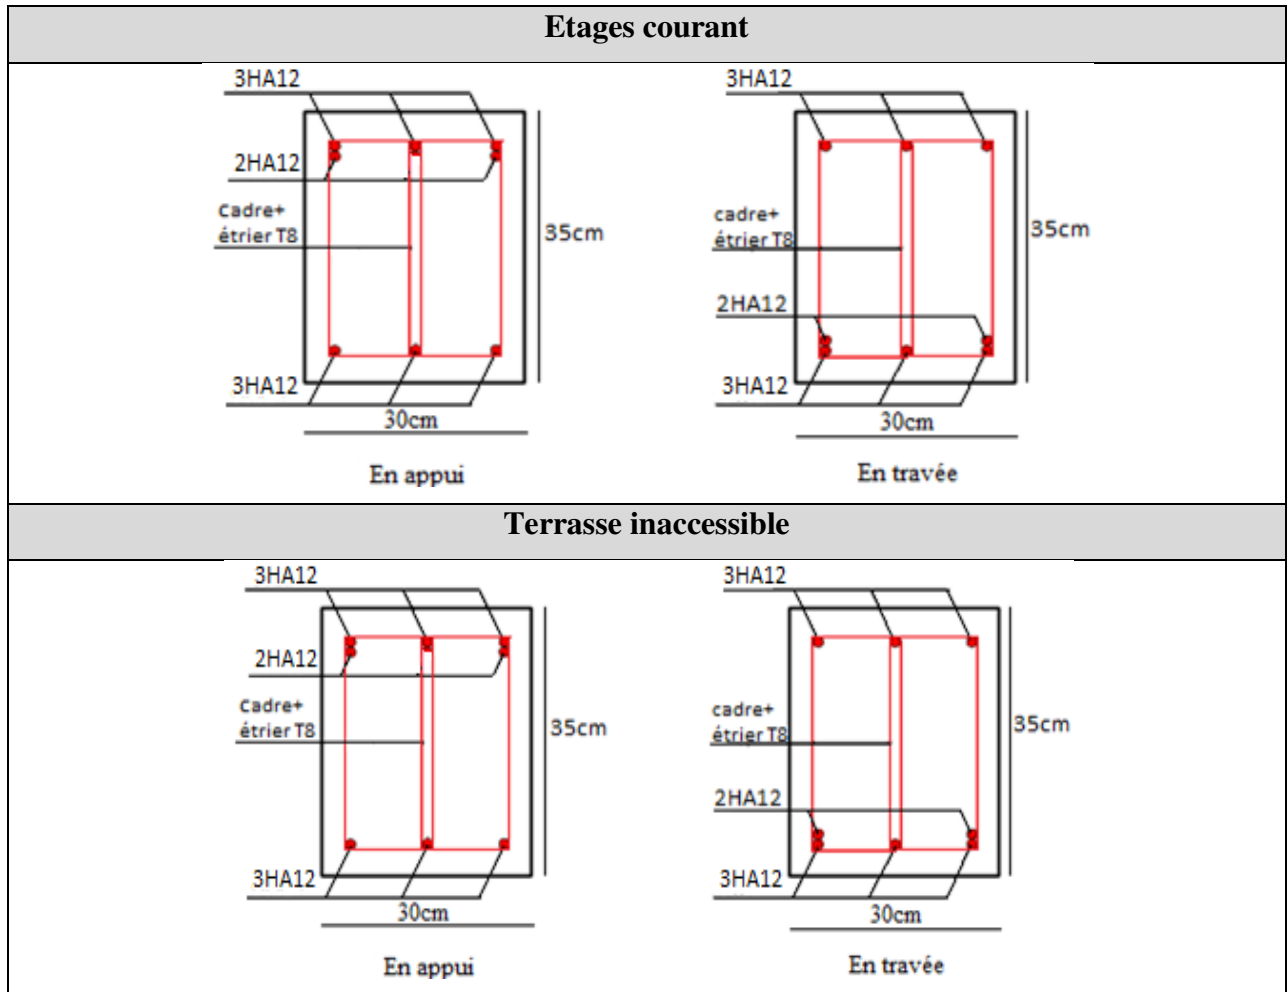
Schéma de ferrailage des poutres secondaires.
